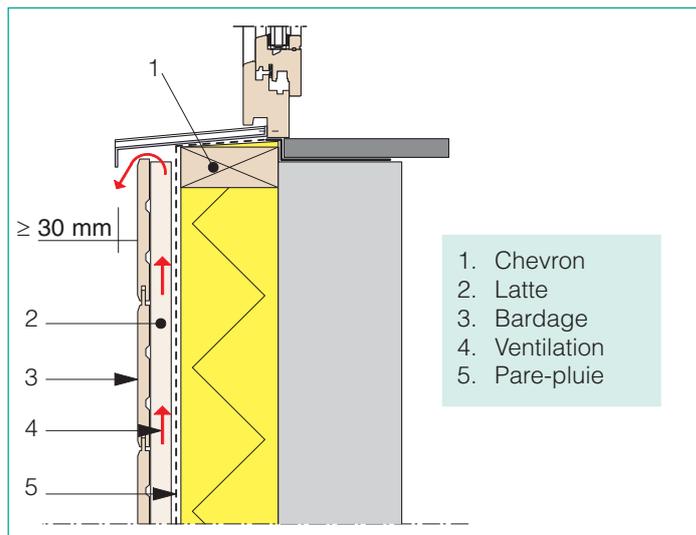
Raccord du bardage avec une menuiserie encastrée dans la façade.
